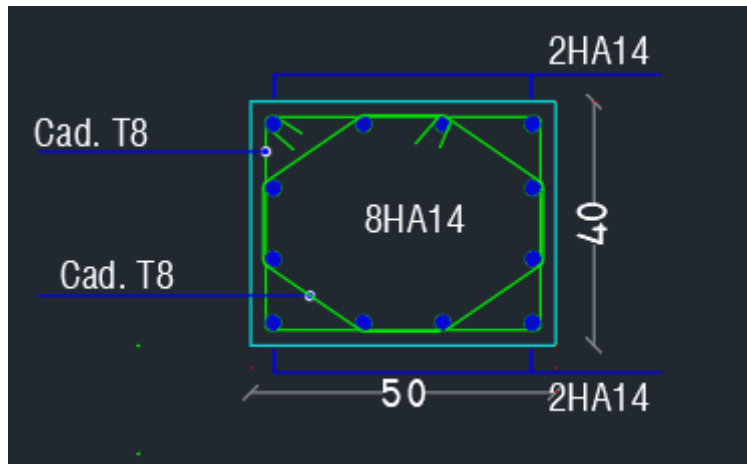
coupe de ferrailage des poteaux 40x50 cm<sup>2</sup>
